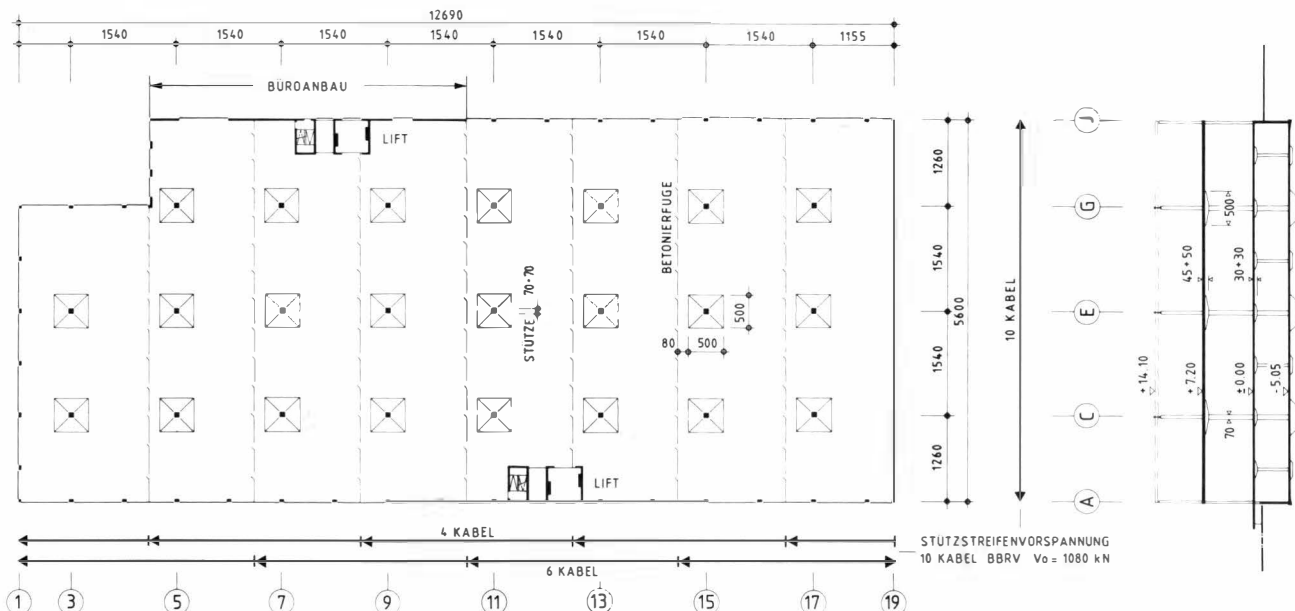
Detail Pilzkopf mit Stützstreifenvorspannung und Betonierfuge – Détail d'un champignon avec précontrainte de la bande d'appui et joint d'étape de bétonnage – Detail of mushroom head with support strip prestressing and concrete pouring joint
